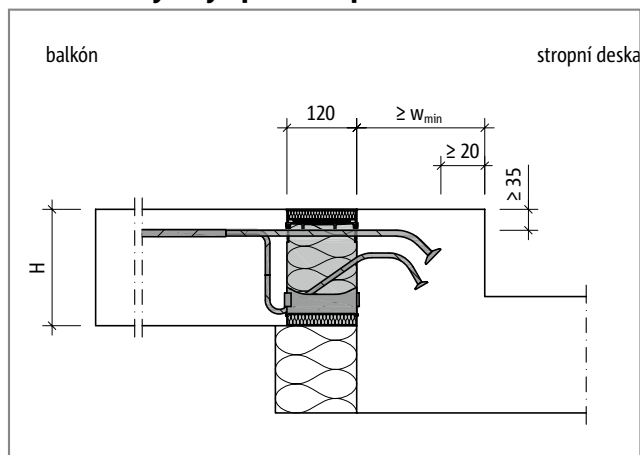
Schöck Isokorb® XT typ KL-U/KL-O: Balkón na zalomené fasádě
